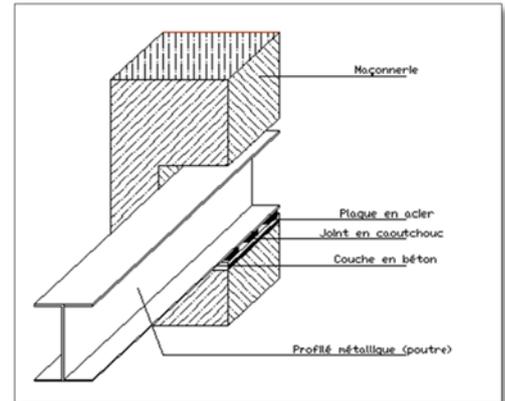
photo montrant un assemblage entre une poutre métallique et un noyau central.
